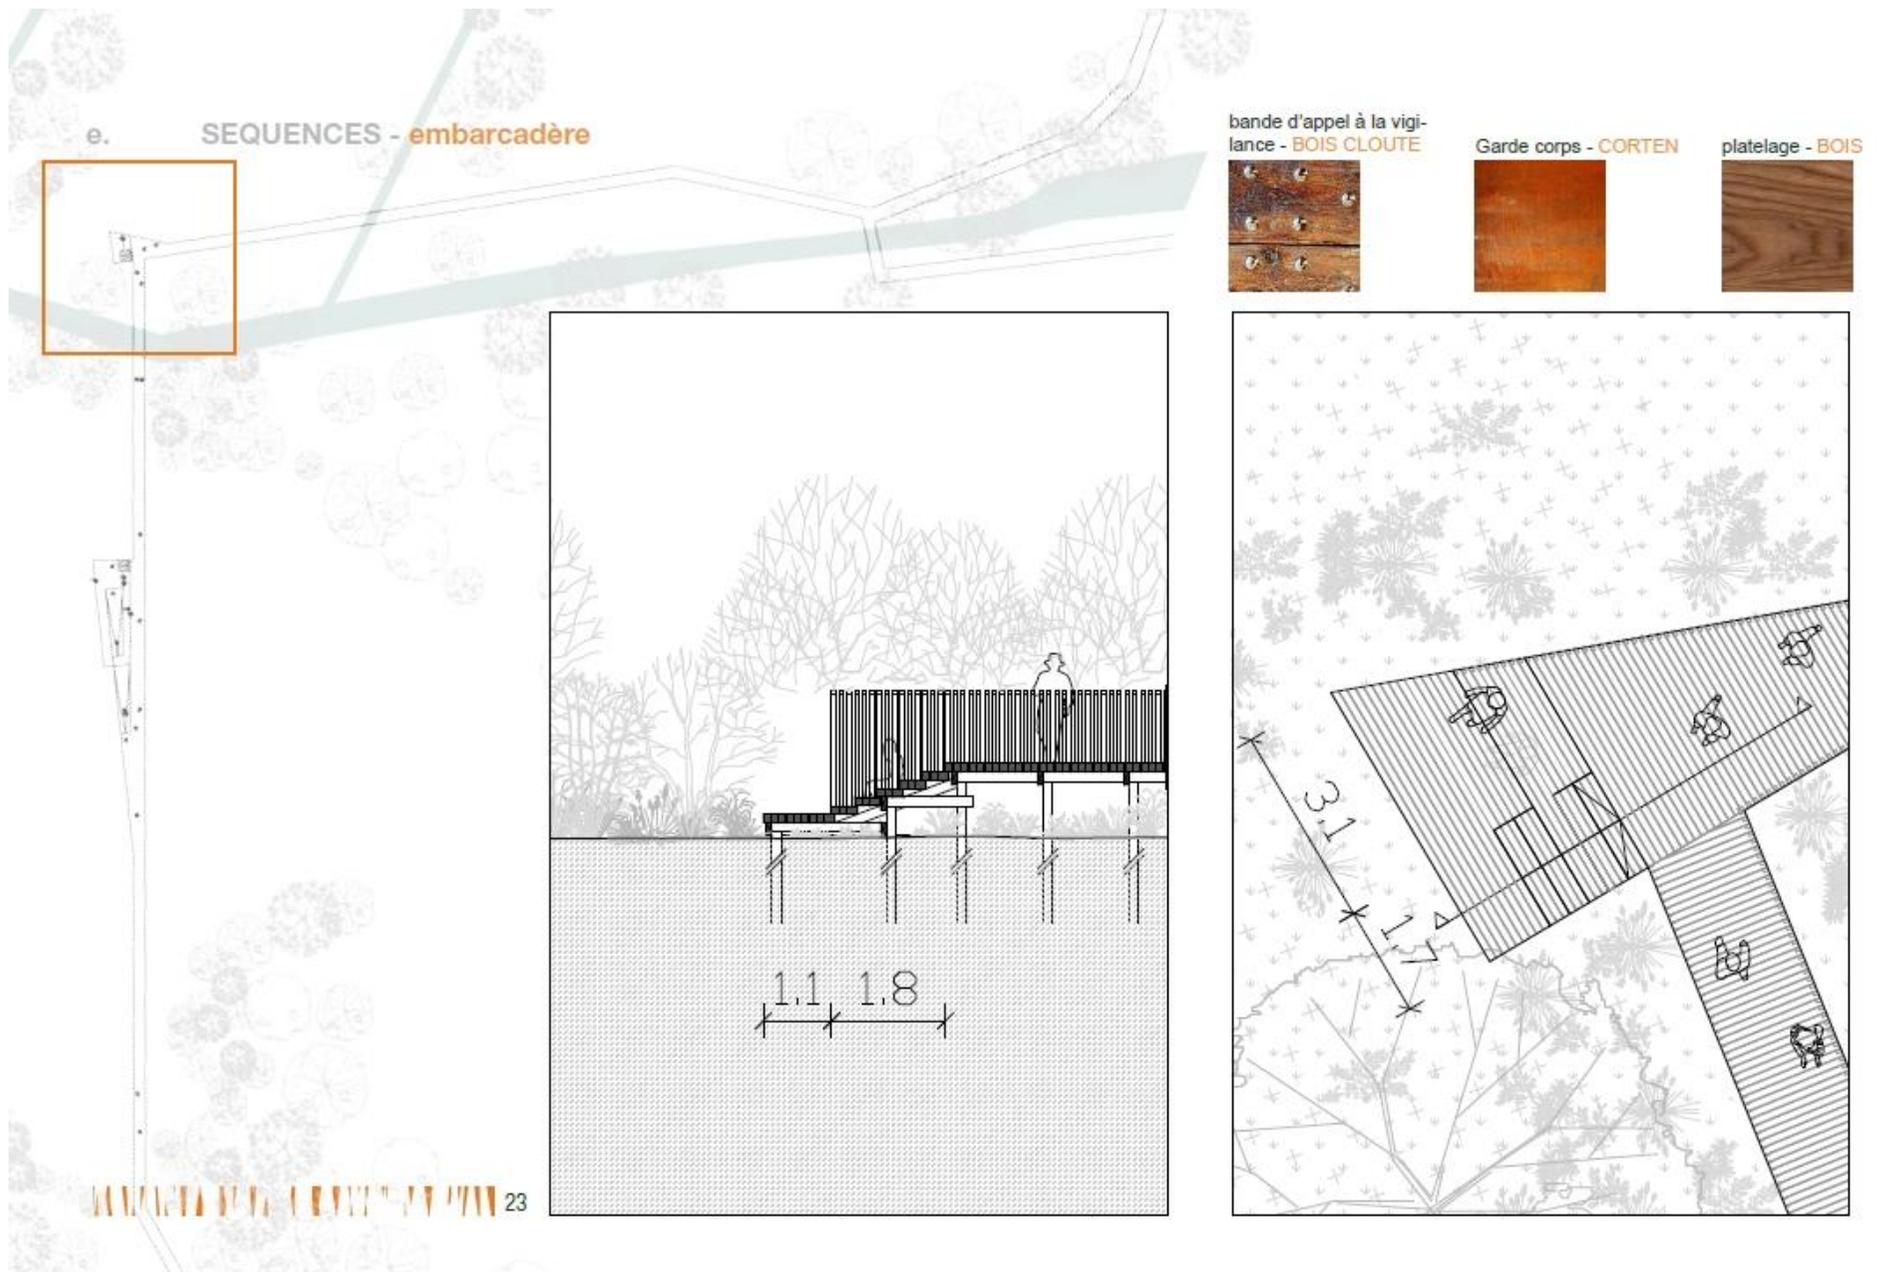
Schéma constructif de « l'embarcadère » (Source : Atelier Arcau)
